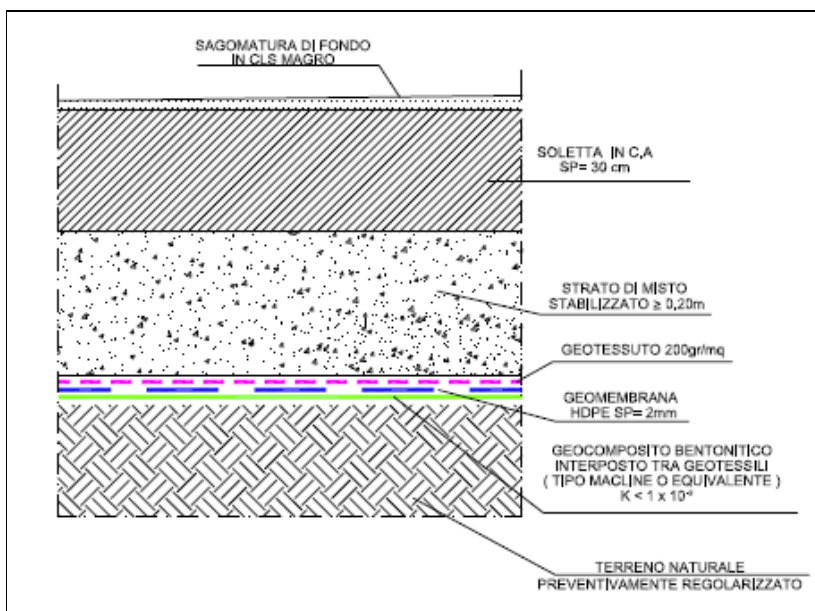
Pacchetto di impermeabilizzazione aree di stoccaggio
